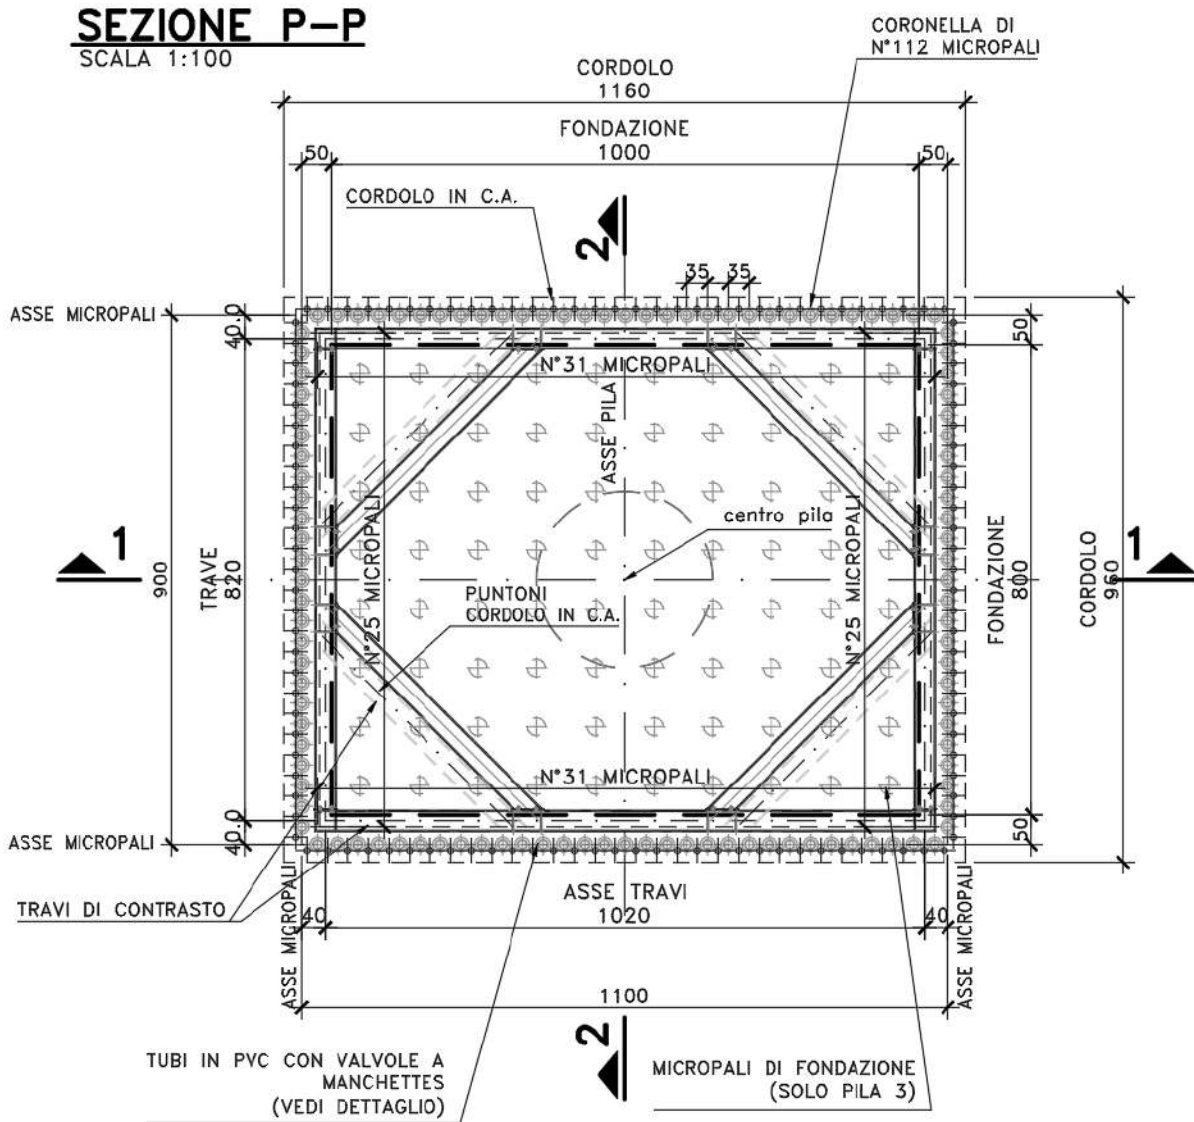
Pianta opere provvisionali – Pila 1 / Pila 3
